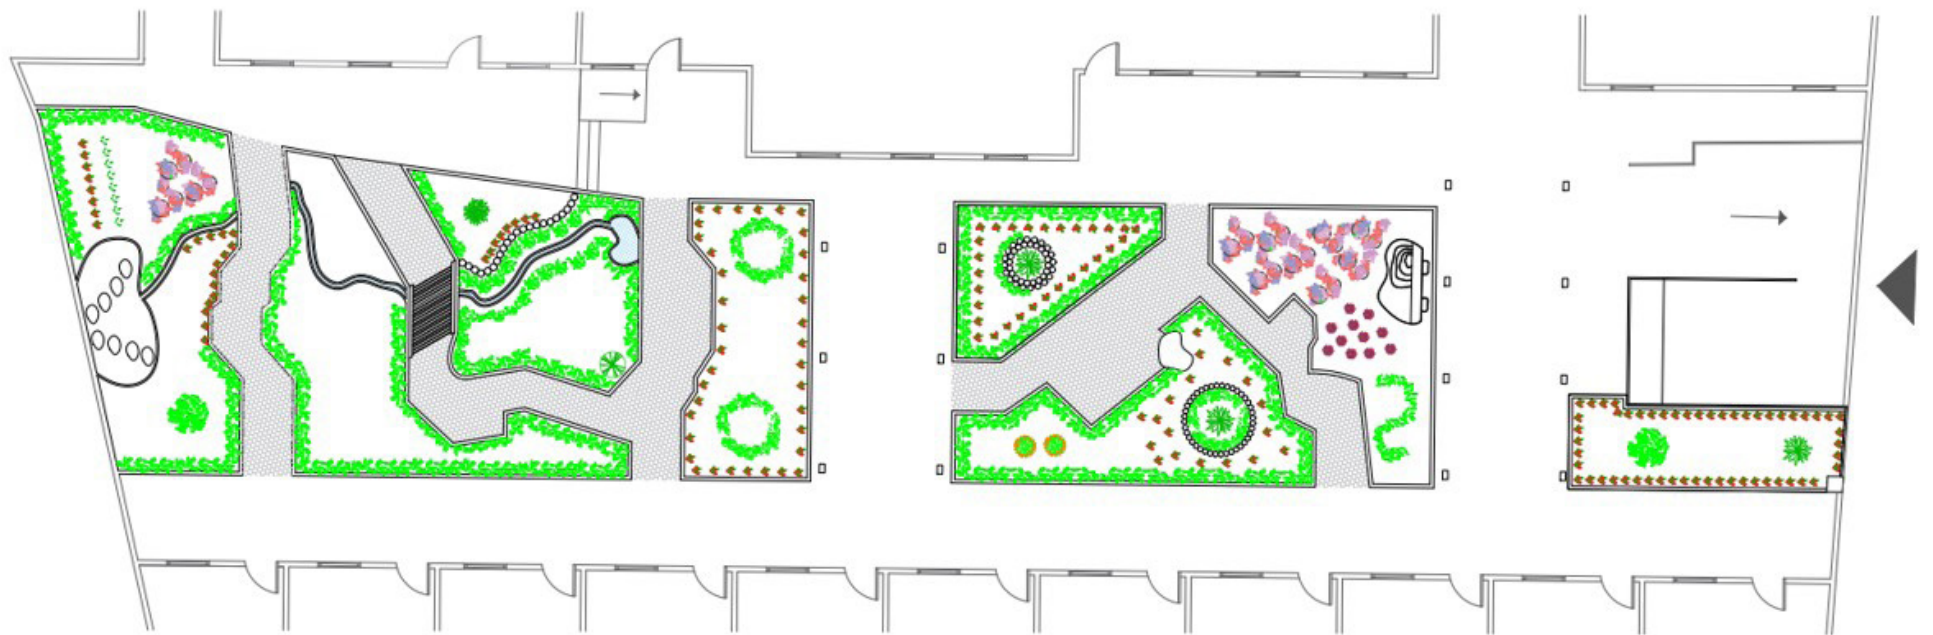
Planta del estado actual de las áreas verdes. (Redrován, 2024).
